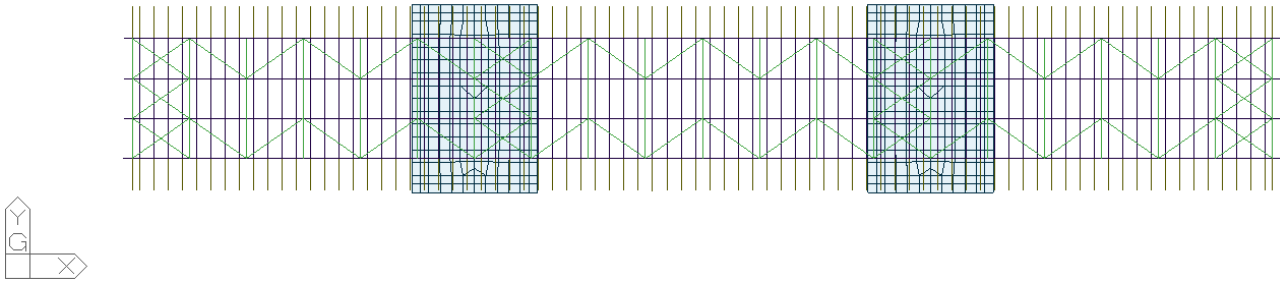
Modellazione tridimensionale Elementi finiti – Vista in pianta
